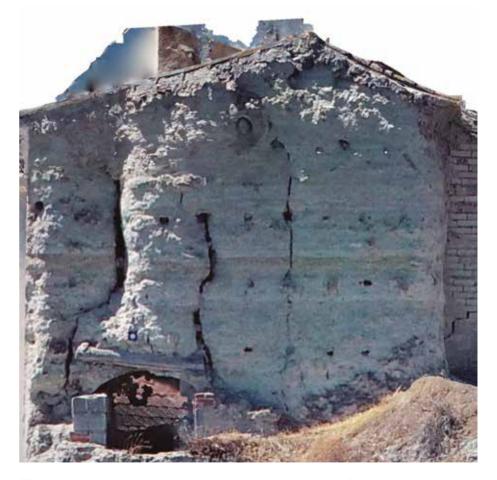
Alzado norte sobre el terreno natural. Se pueden observar las grietas que amenazan a su conservación.
